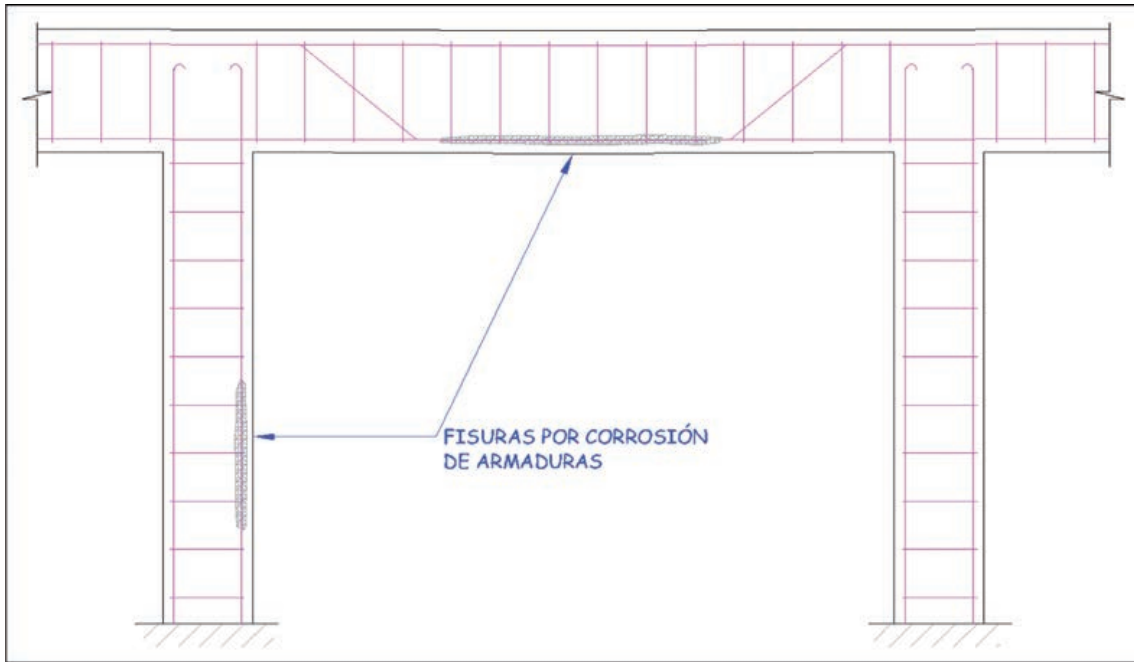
FISURAS POR CORROSIÓN DE ARMADURAS.
